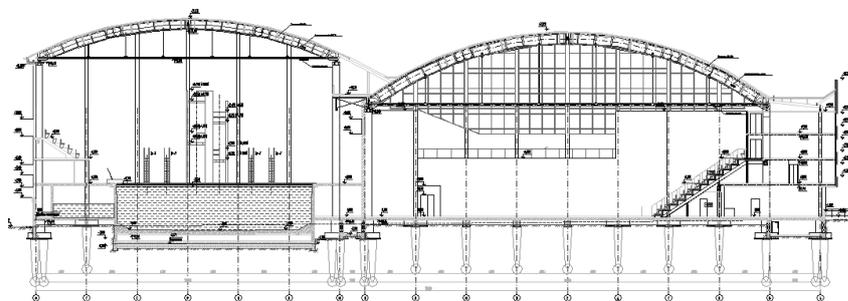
Продольный разрез здания(показать поперечный разрез своего здания)
